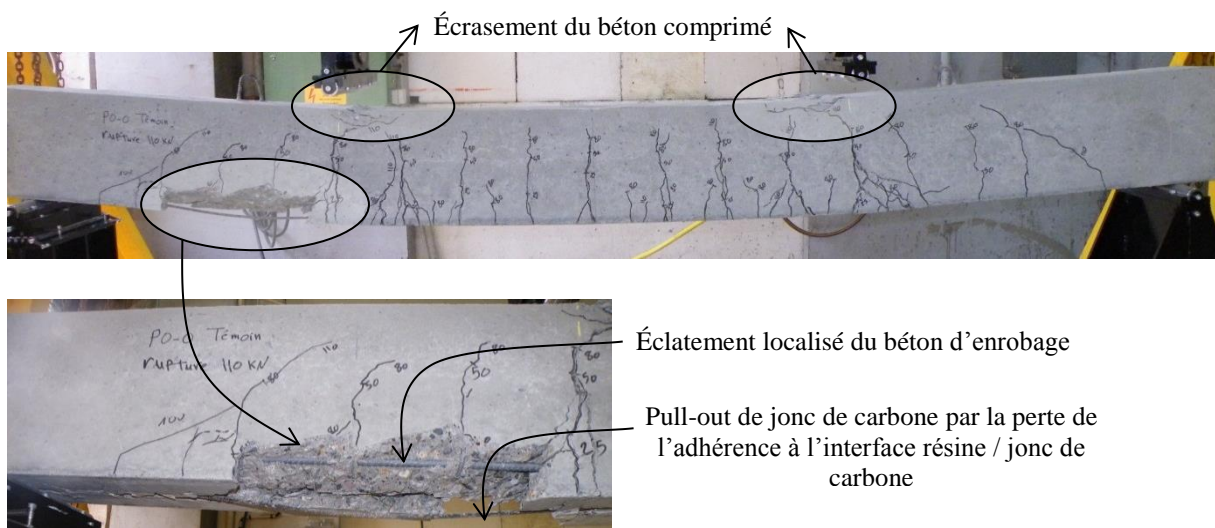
Mode de ruine de la poutre témoin renforcée P0-0.
